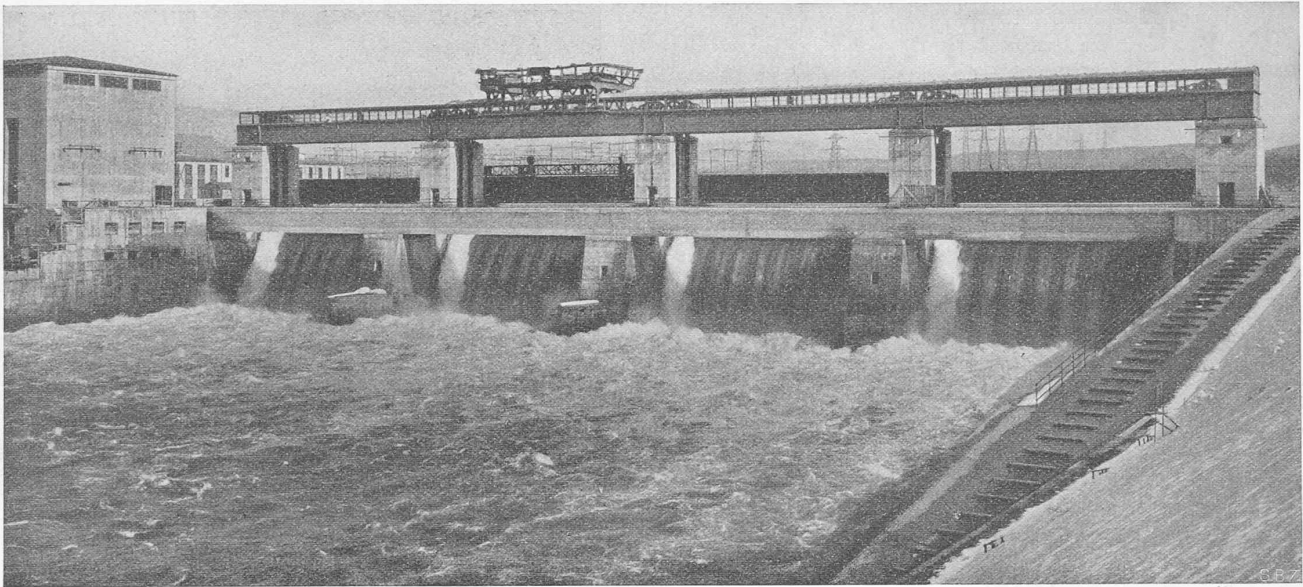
Unterwasserseitige Ansicht des Stauwehrs, vom schweizerischen Ufer aus. Links das Maschinenhaus, rechts die Kahnrampe.
